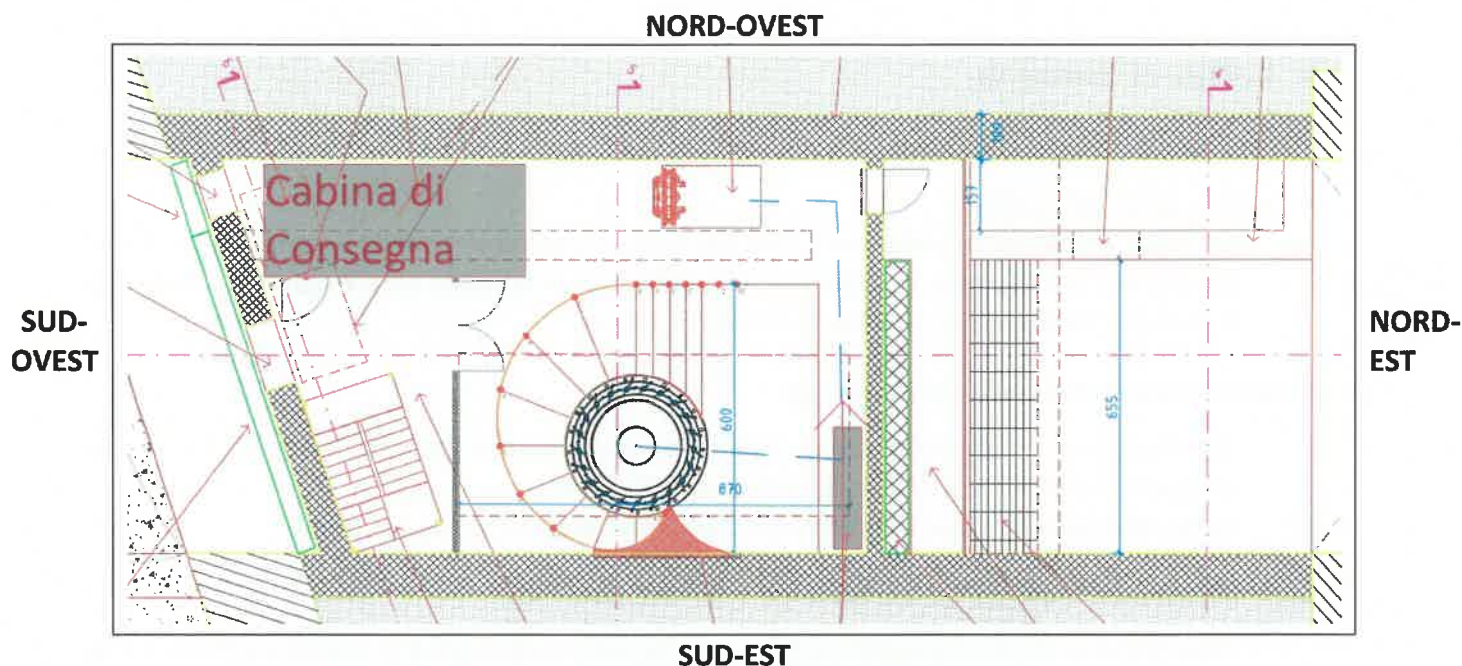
Pianta del locale Cabina Elettrica al piano interrato
